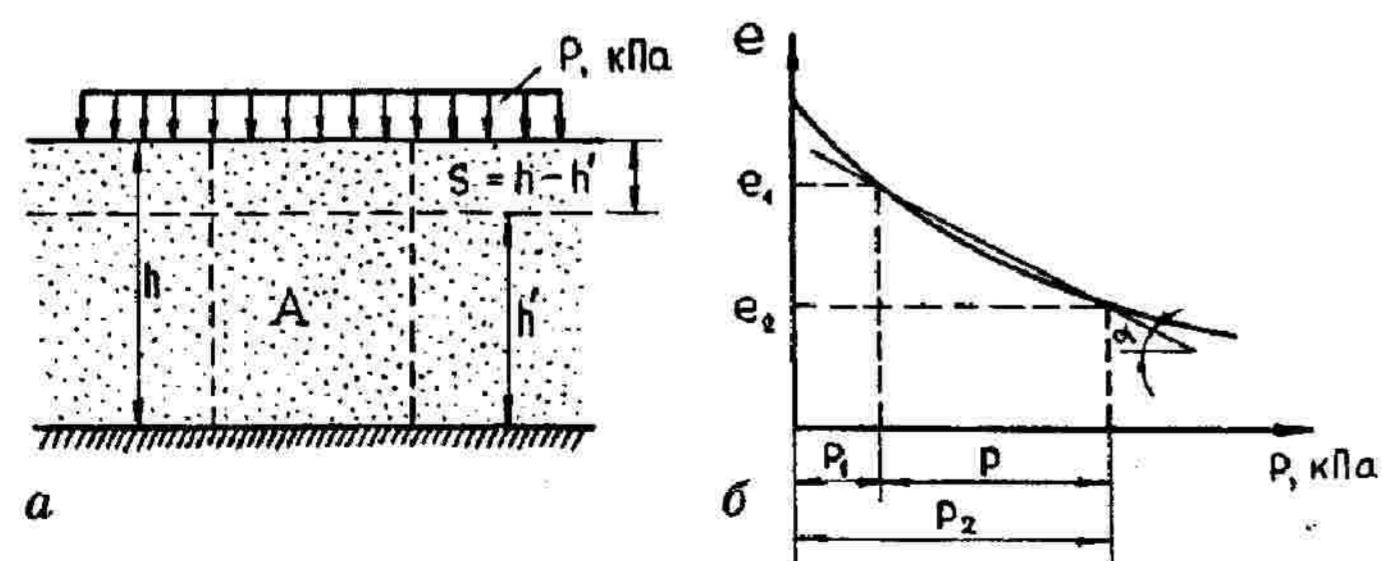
Схема испытания грунта при сплошной нагрузке:
